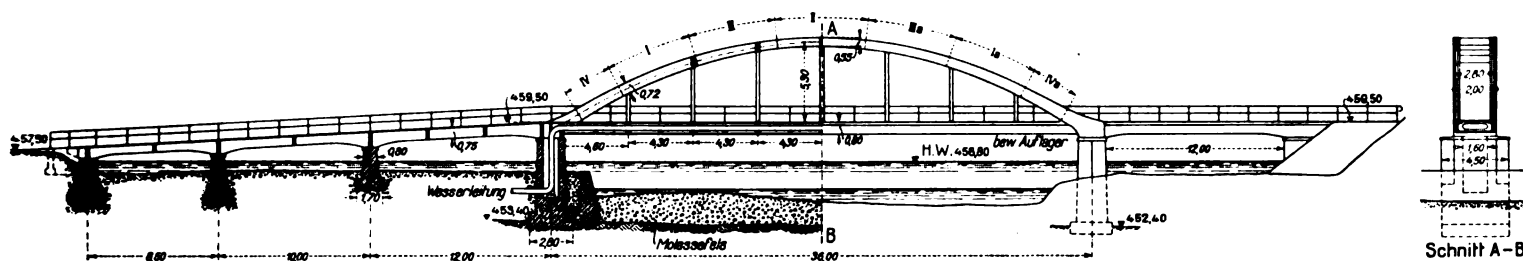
Längs- und Querschnitt und Ansicht der Eisenbeton-Bogenbrücke über die Emme bei Gerlafingen; Gesamtlänge 84 m. — Maassstab 1:500.
